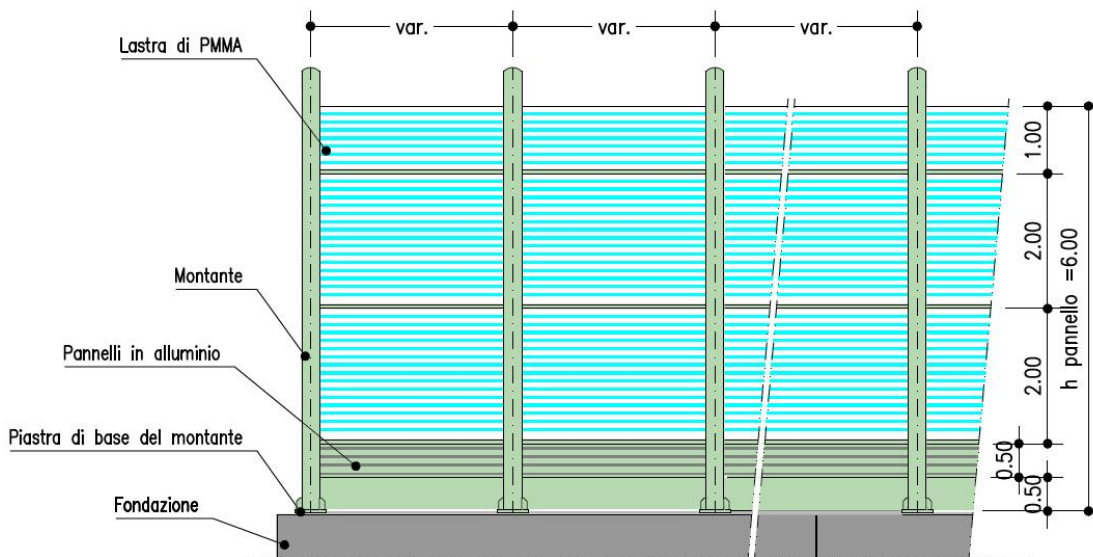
Barriera TRASPARENTE H=6m – Prospetto lato ricettore
